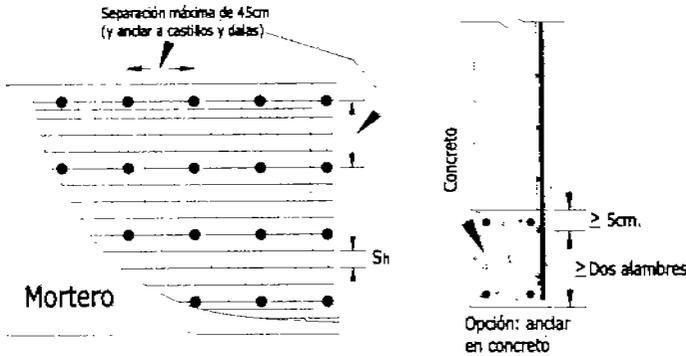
b) REFUERZO CON MALLA DE ALAMBRE SOLDADO Y RECUBRIMIENTO DE MORTERO
